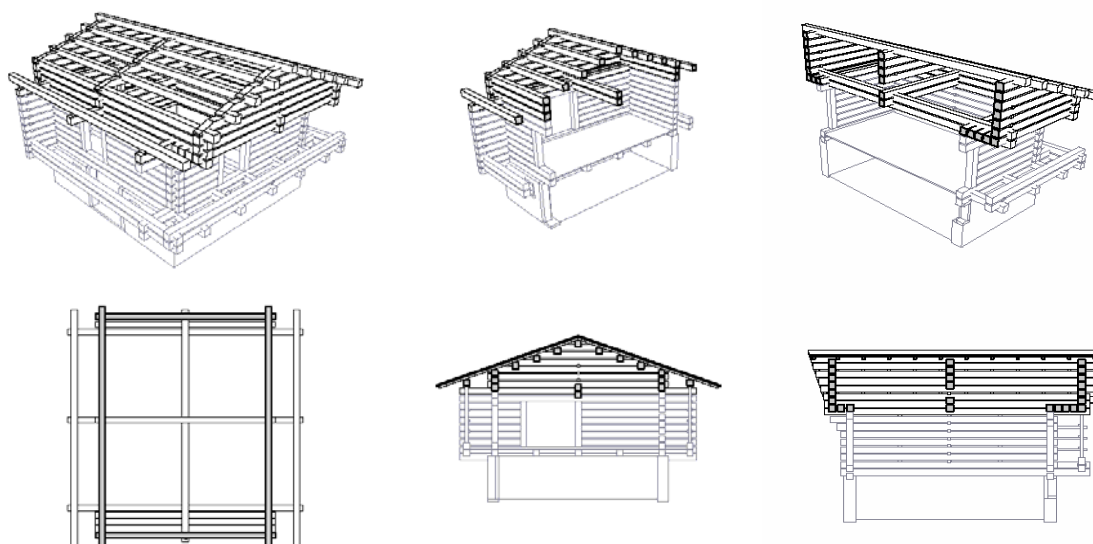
Rappresentazione tridimensionale, pianta e sezioni del corpo di copertura
